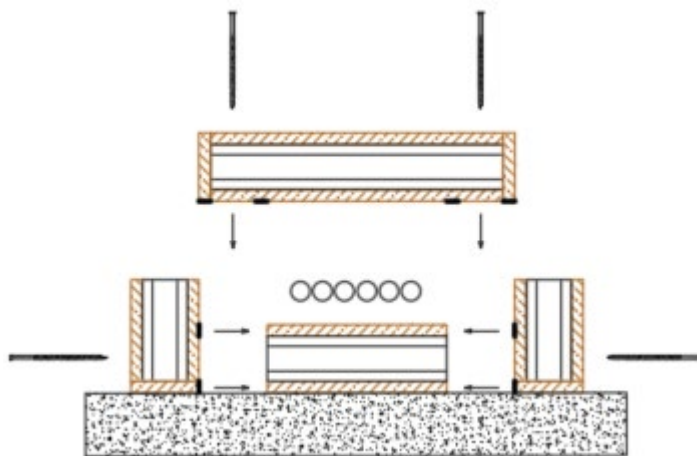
Схема сборки элементов короба-лотка на рабочем месте
